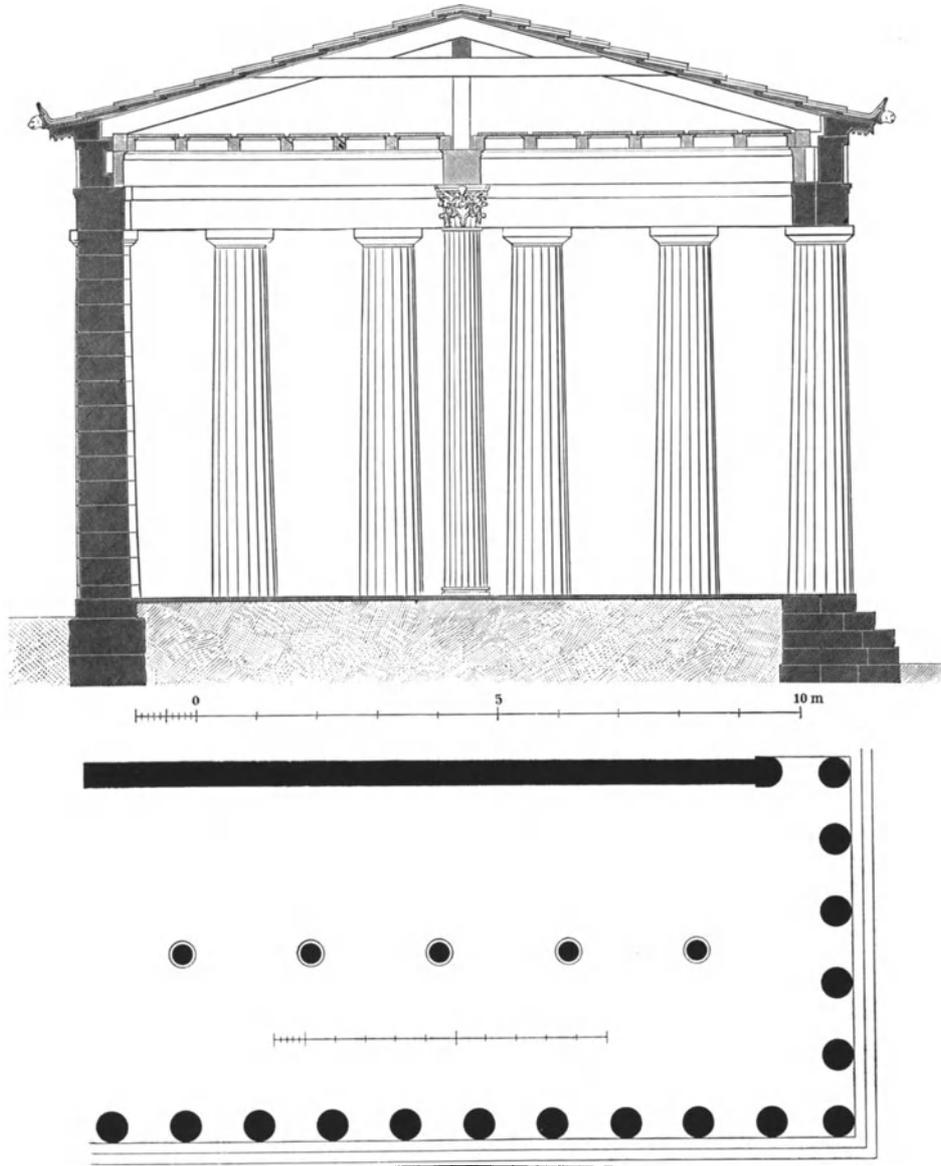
97. Südliche Wandelhalle in Olympia. Schnitt 1 : 125. Grundriß 1 : 250.
